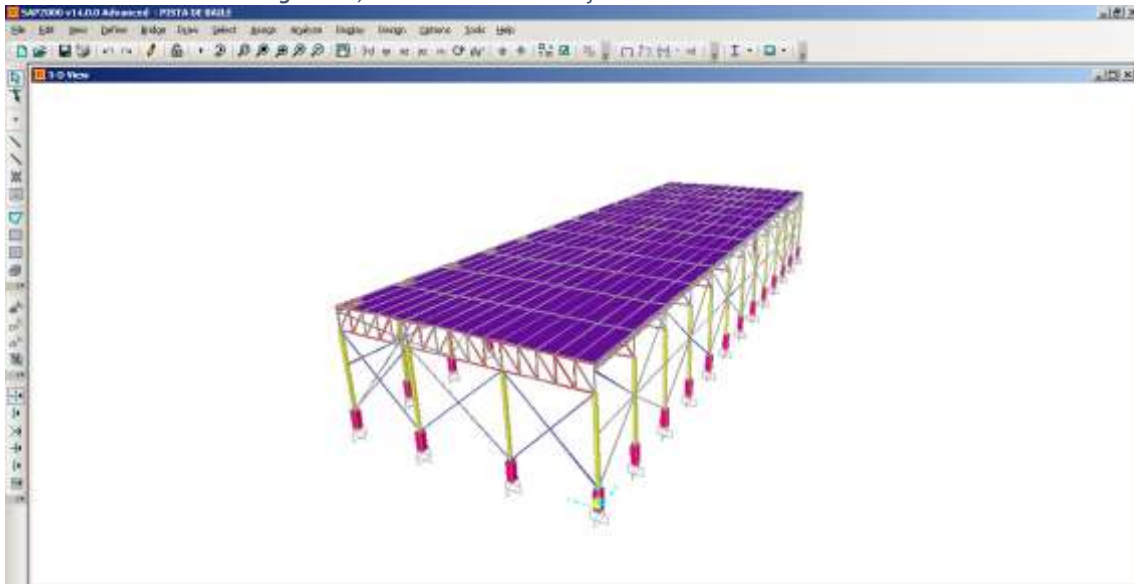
, Modelamiento de la infraestructura del Vivero, estructura metálica, invernadero
